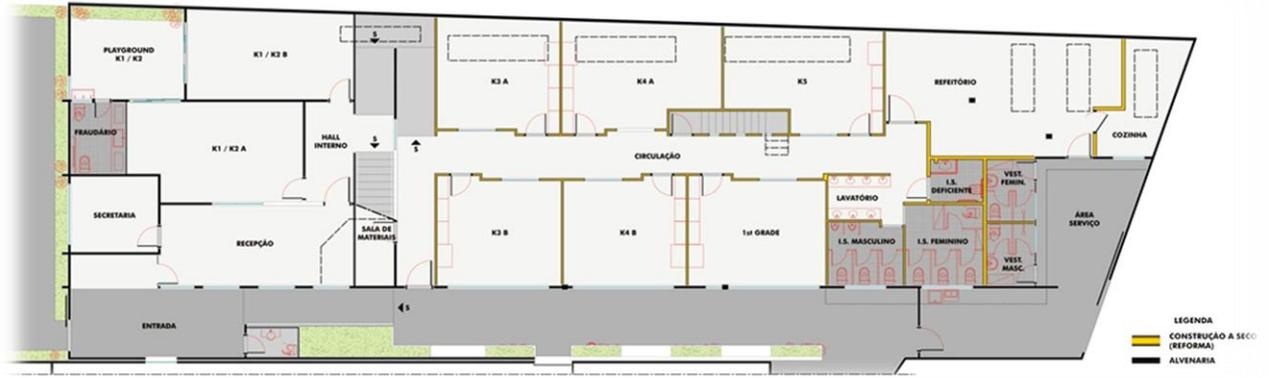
Planta 1º Pavimento - Escola *Builders*.
